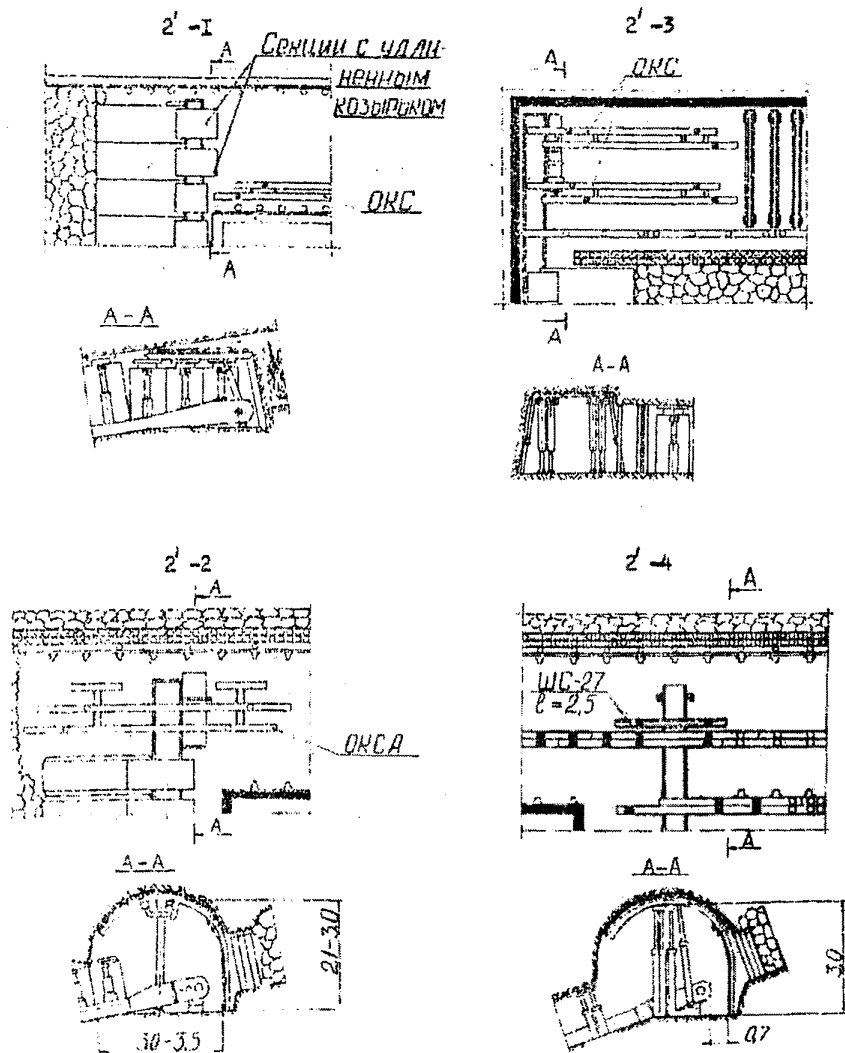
Типовые схемы крепления сопряжений у вентиляционной (рельсовой) выработки
